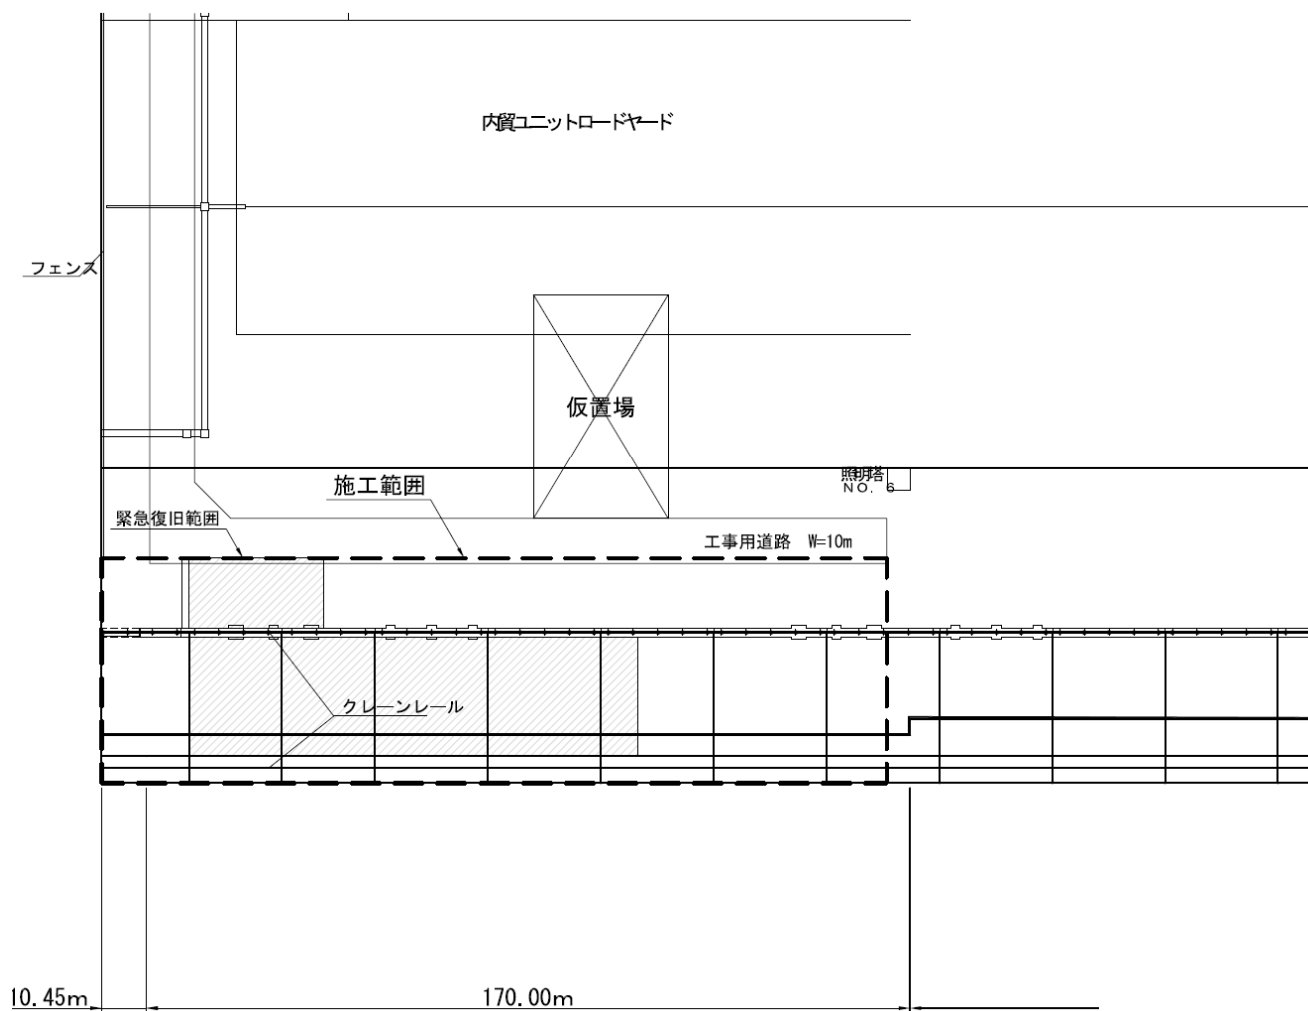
81 No.4 常陸那珂港区\_北ふ頭岸壁(-10m)の平面図 (被災後)
